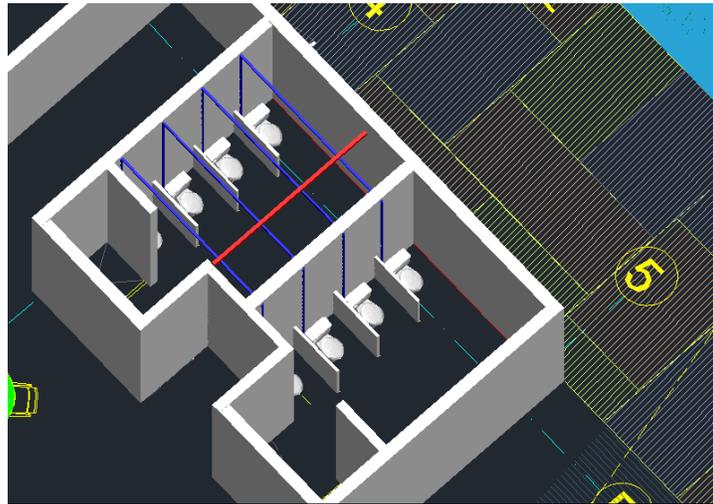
Esquema en alzado del proyecto, distribución de tuberías grises a la vista
